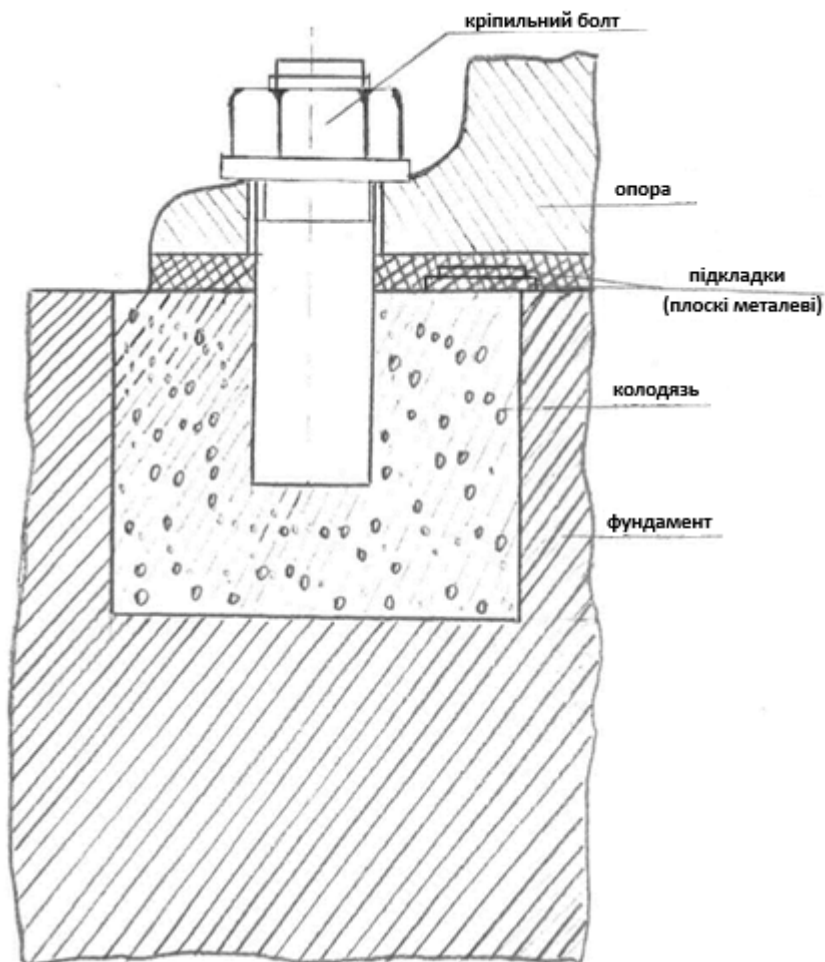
Кріплення етикетувальної машини до фундаменту
